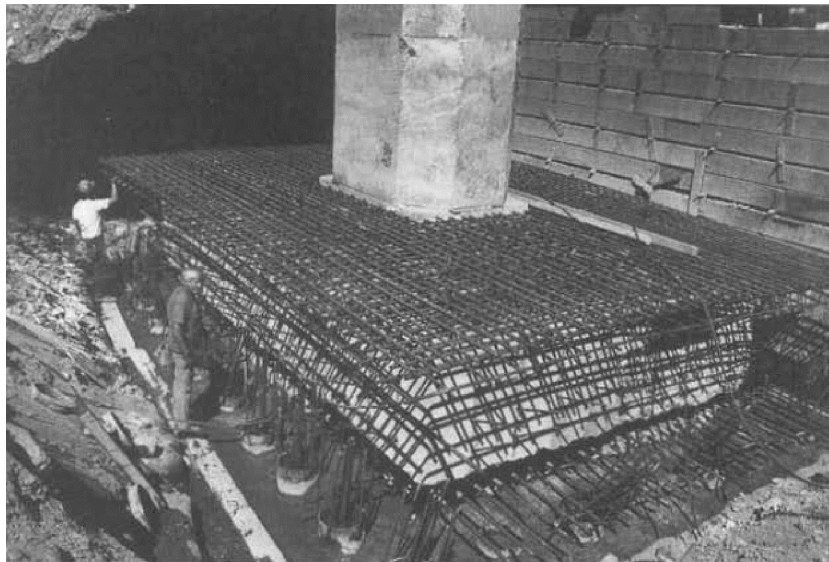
Ndërhyrje strukturore në themel me rritje të përmasave në plan, armaturë shtesë dhe pilota
